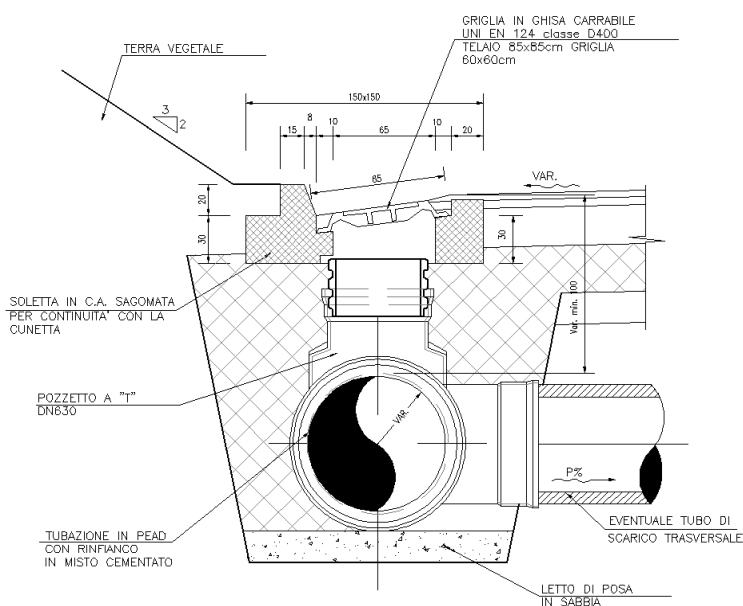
sezione tipo elemento di drenaggio in trincea.
